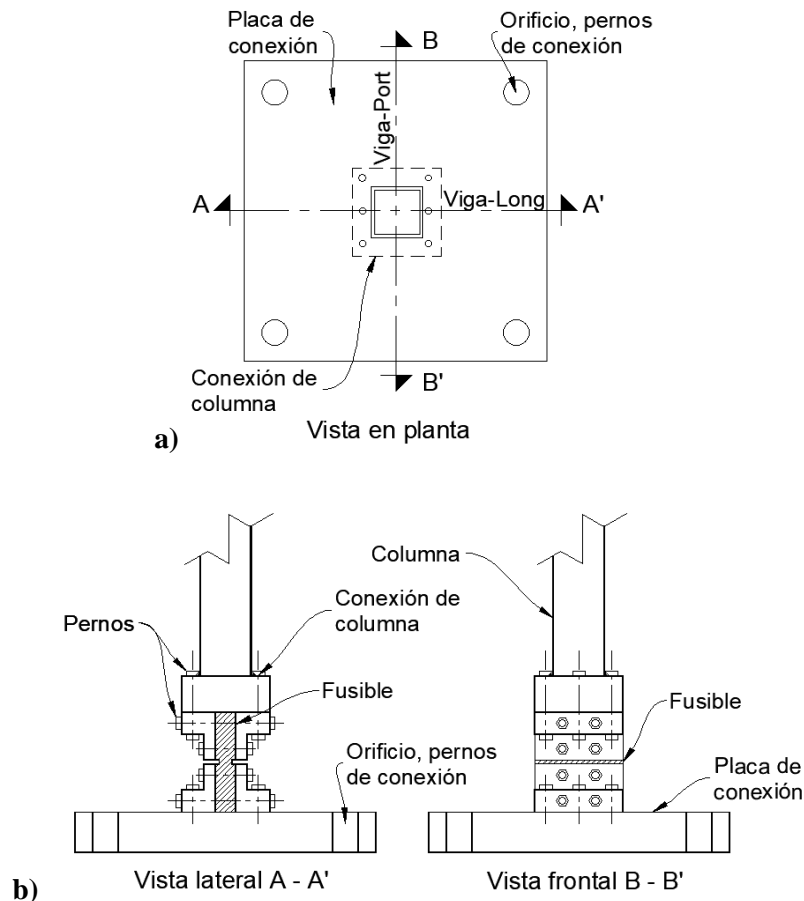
a) Planta tipo de conexión placa base-columna y b) Vista lateral y frontal
